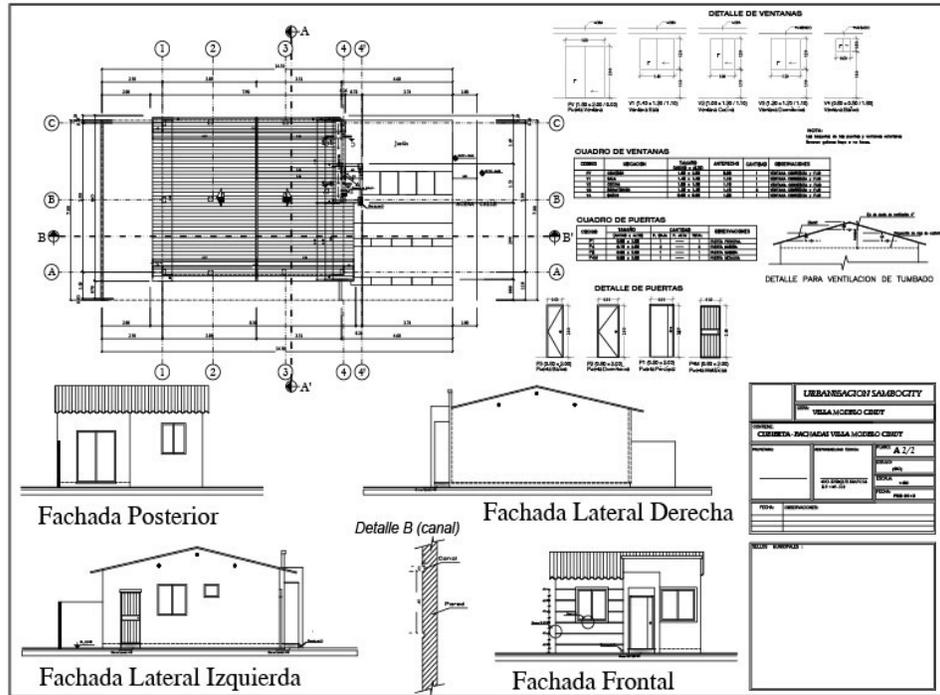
Planos Arquitectónicos del Proyecto. Villa Modelo Cindy
